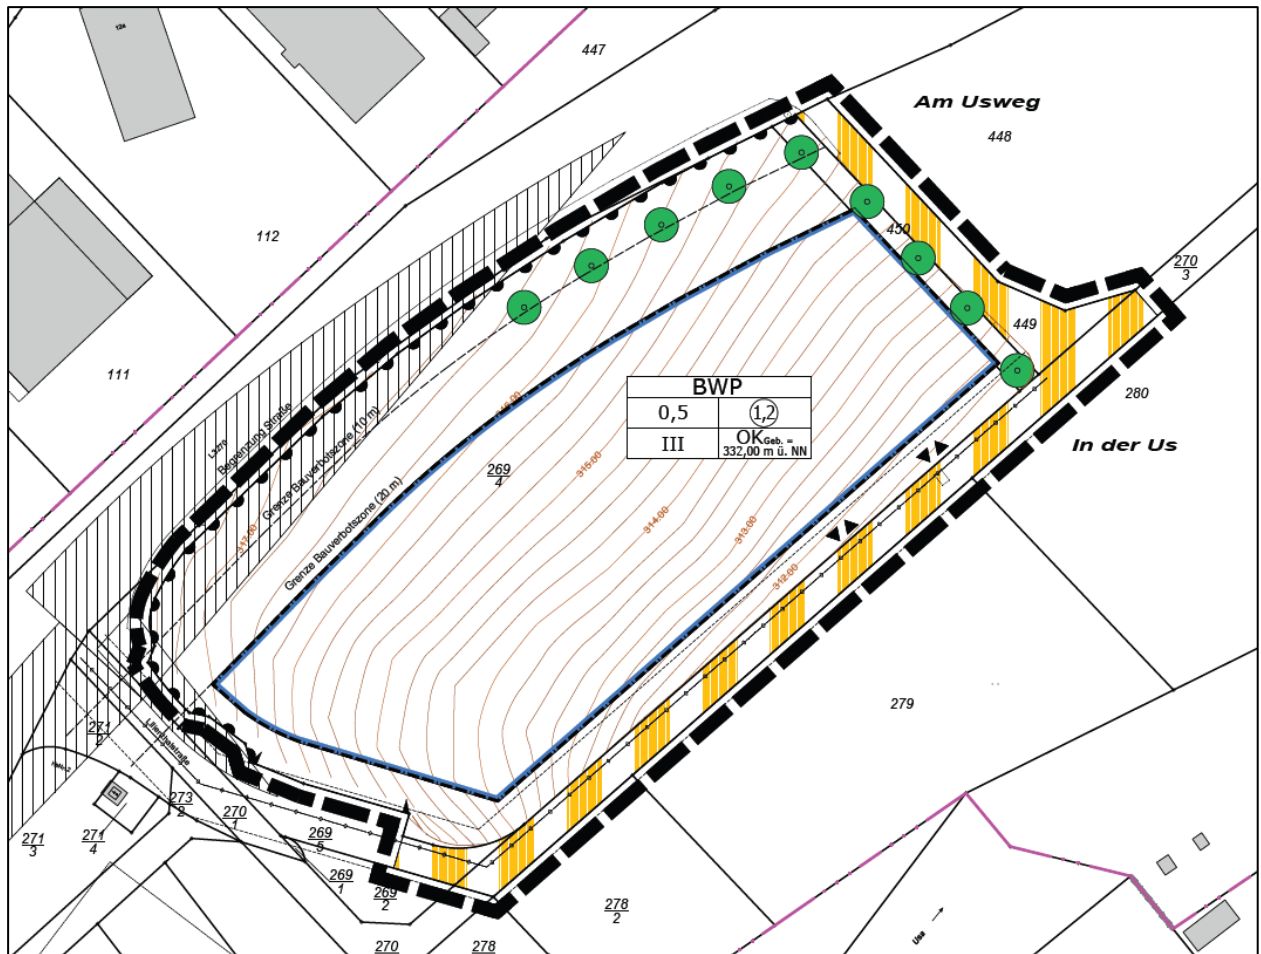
Ausschnitt aus der Plankarte zum Bebauungsplan „Pflegecampus Kleeblatt“. (Plan | ES, Stand 09.07.2024)
